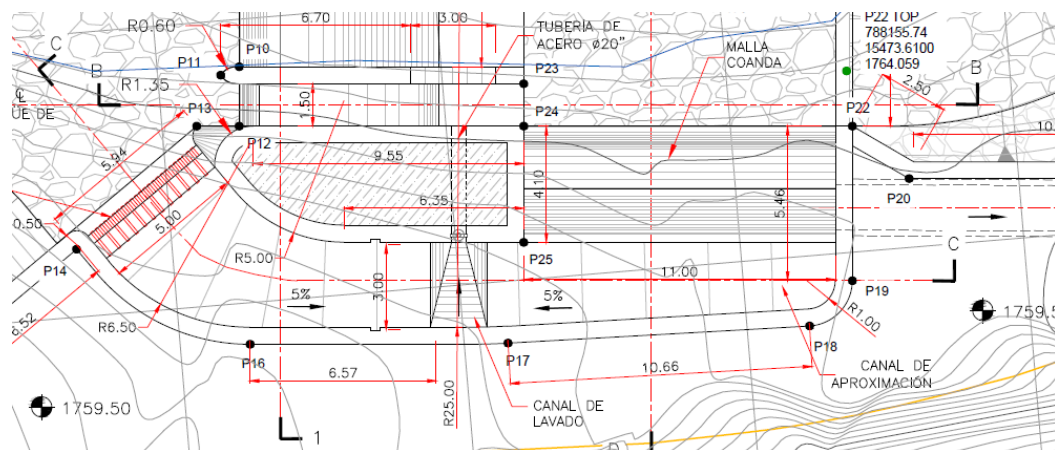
Vista Zona Malla Coanda San José de Minas
